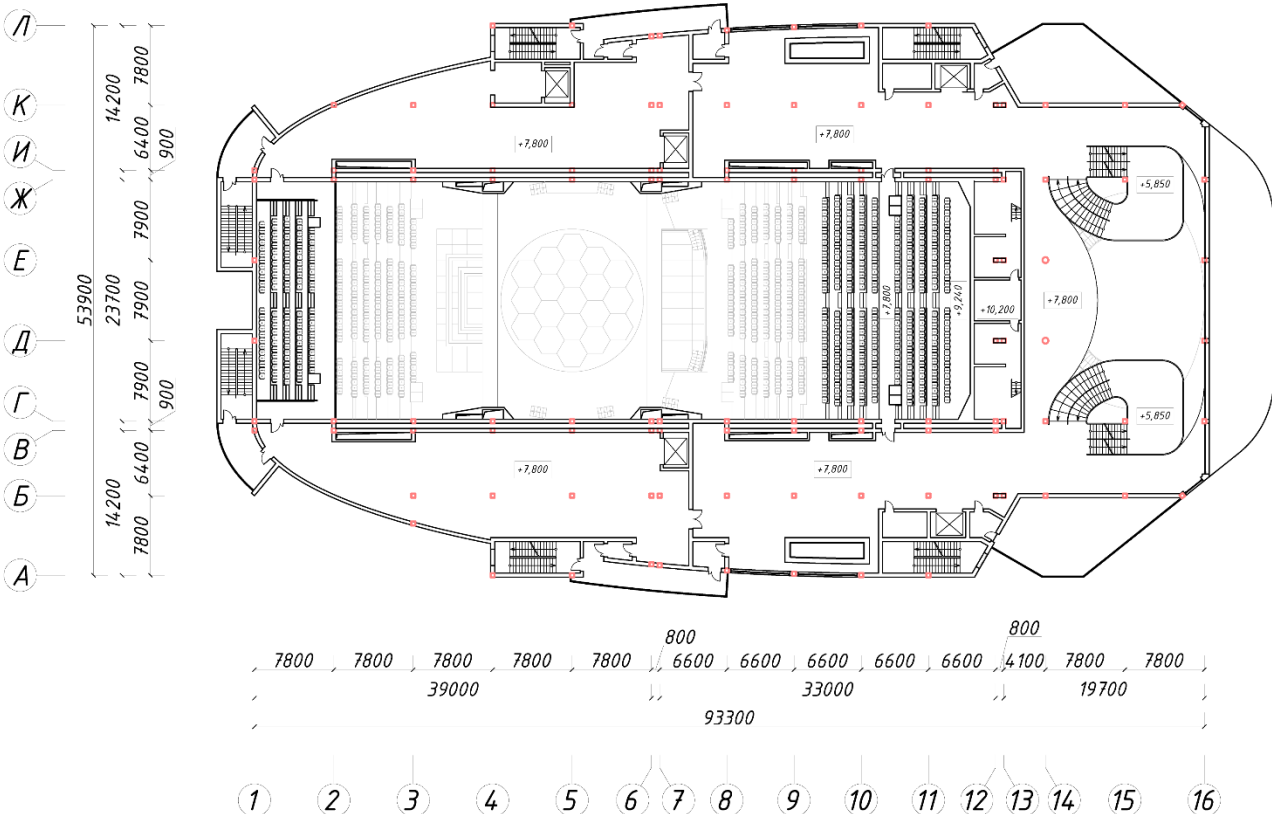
Схема плану поверху на позначці +7.800.
